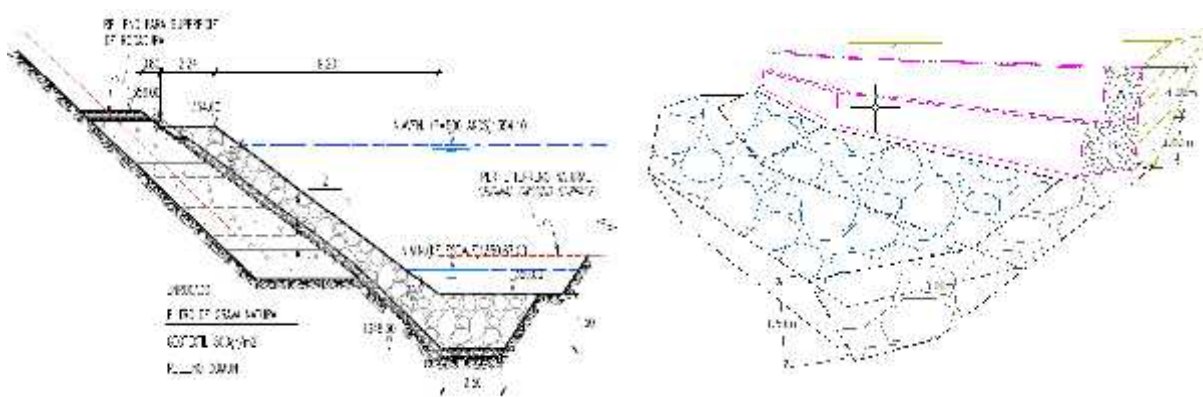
Estructura mediante enrocado y enrocado - gavión.
